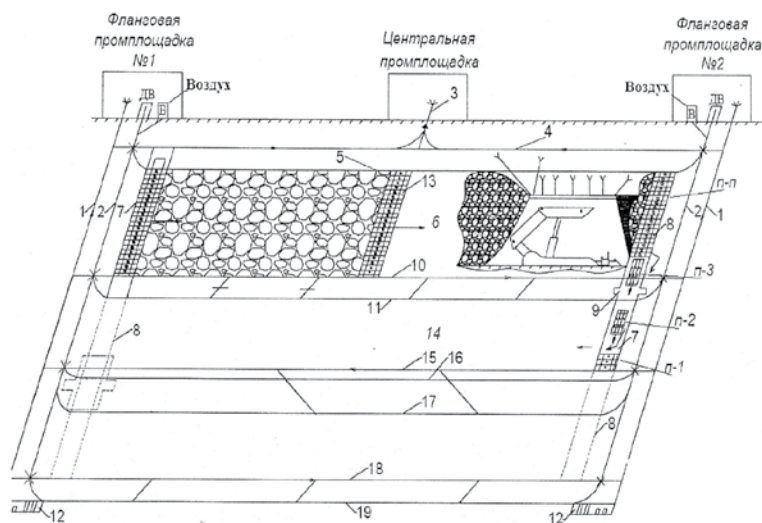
Способ разработки наклонного угольного пласта по патенту РФ №2515791
